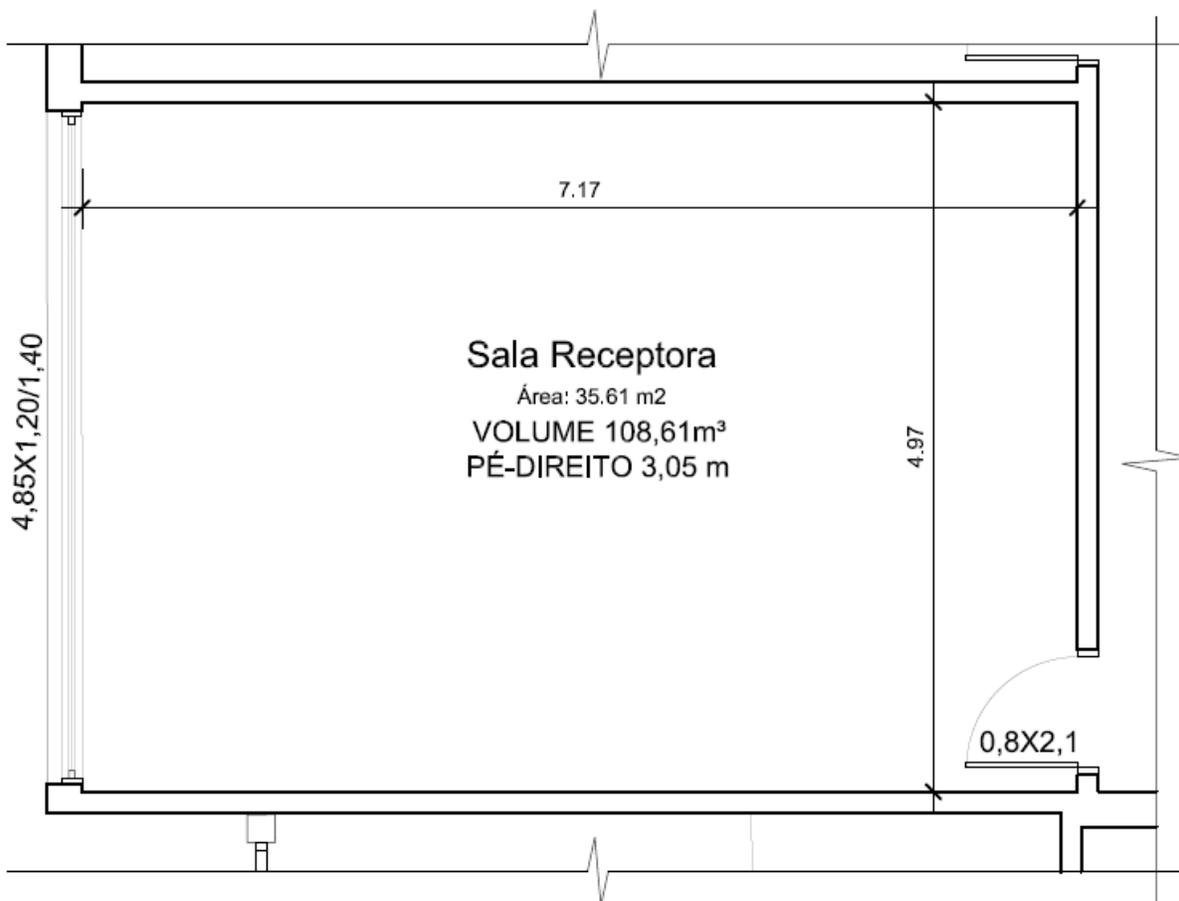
Planta baixa da sala receptora, tipologia de laje: Laje treliçada.
